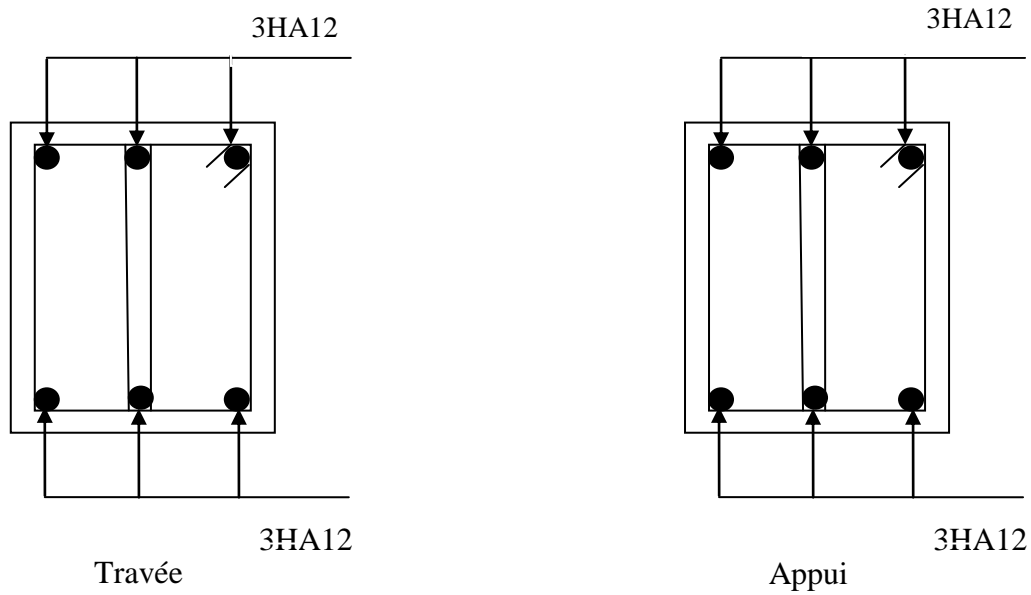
Schéma de ferrailage de la poutre secondaire (30×40) de la terrasse
